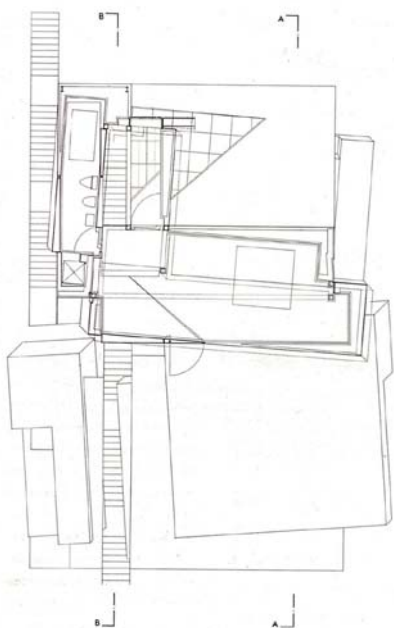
Planta piso Inferior (Levene, et al., 1989 p. 74)
